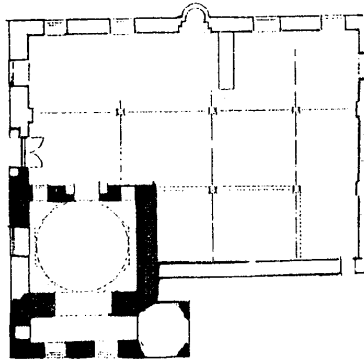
مسقط أفقي لقبة أبي تميم
